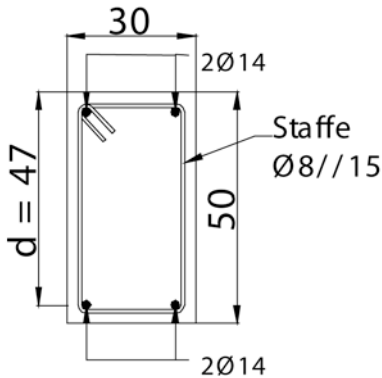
Armatura longitudinale e a taglio della sezione 2.
